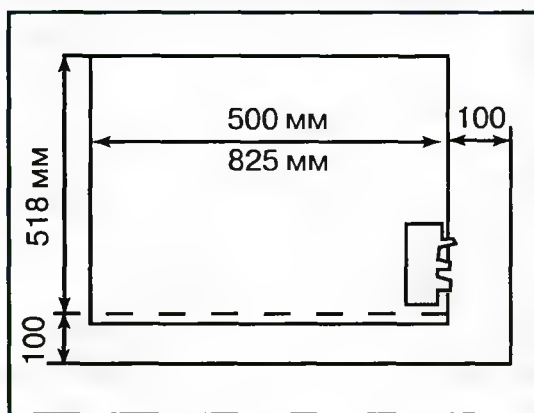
Монтажная плата для фэнкойла ELFO
